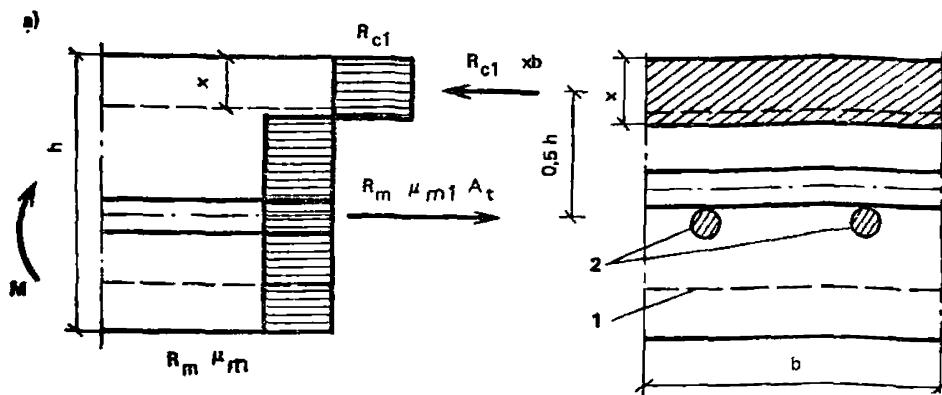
Схема усилий и эпюра напряжений в изгибаемых элементах прямоугольного сечения с сосредоточенной стержневой и проволочной арматурой
